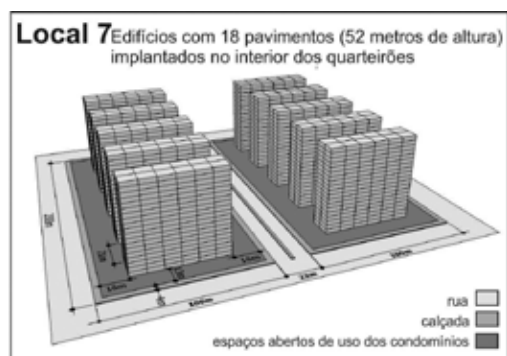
| Edifícios com 18 pavimentos implantados no interior dos quarteirões. Fonte: autores.
